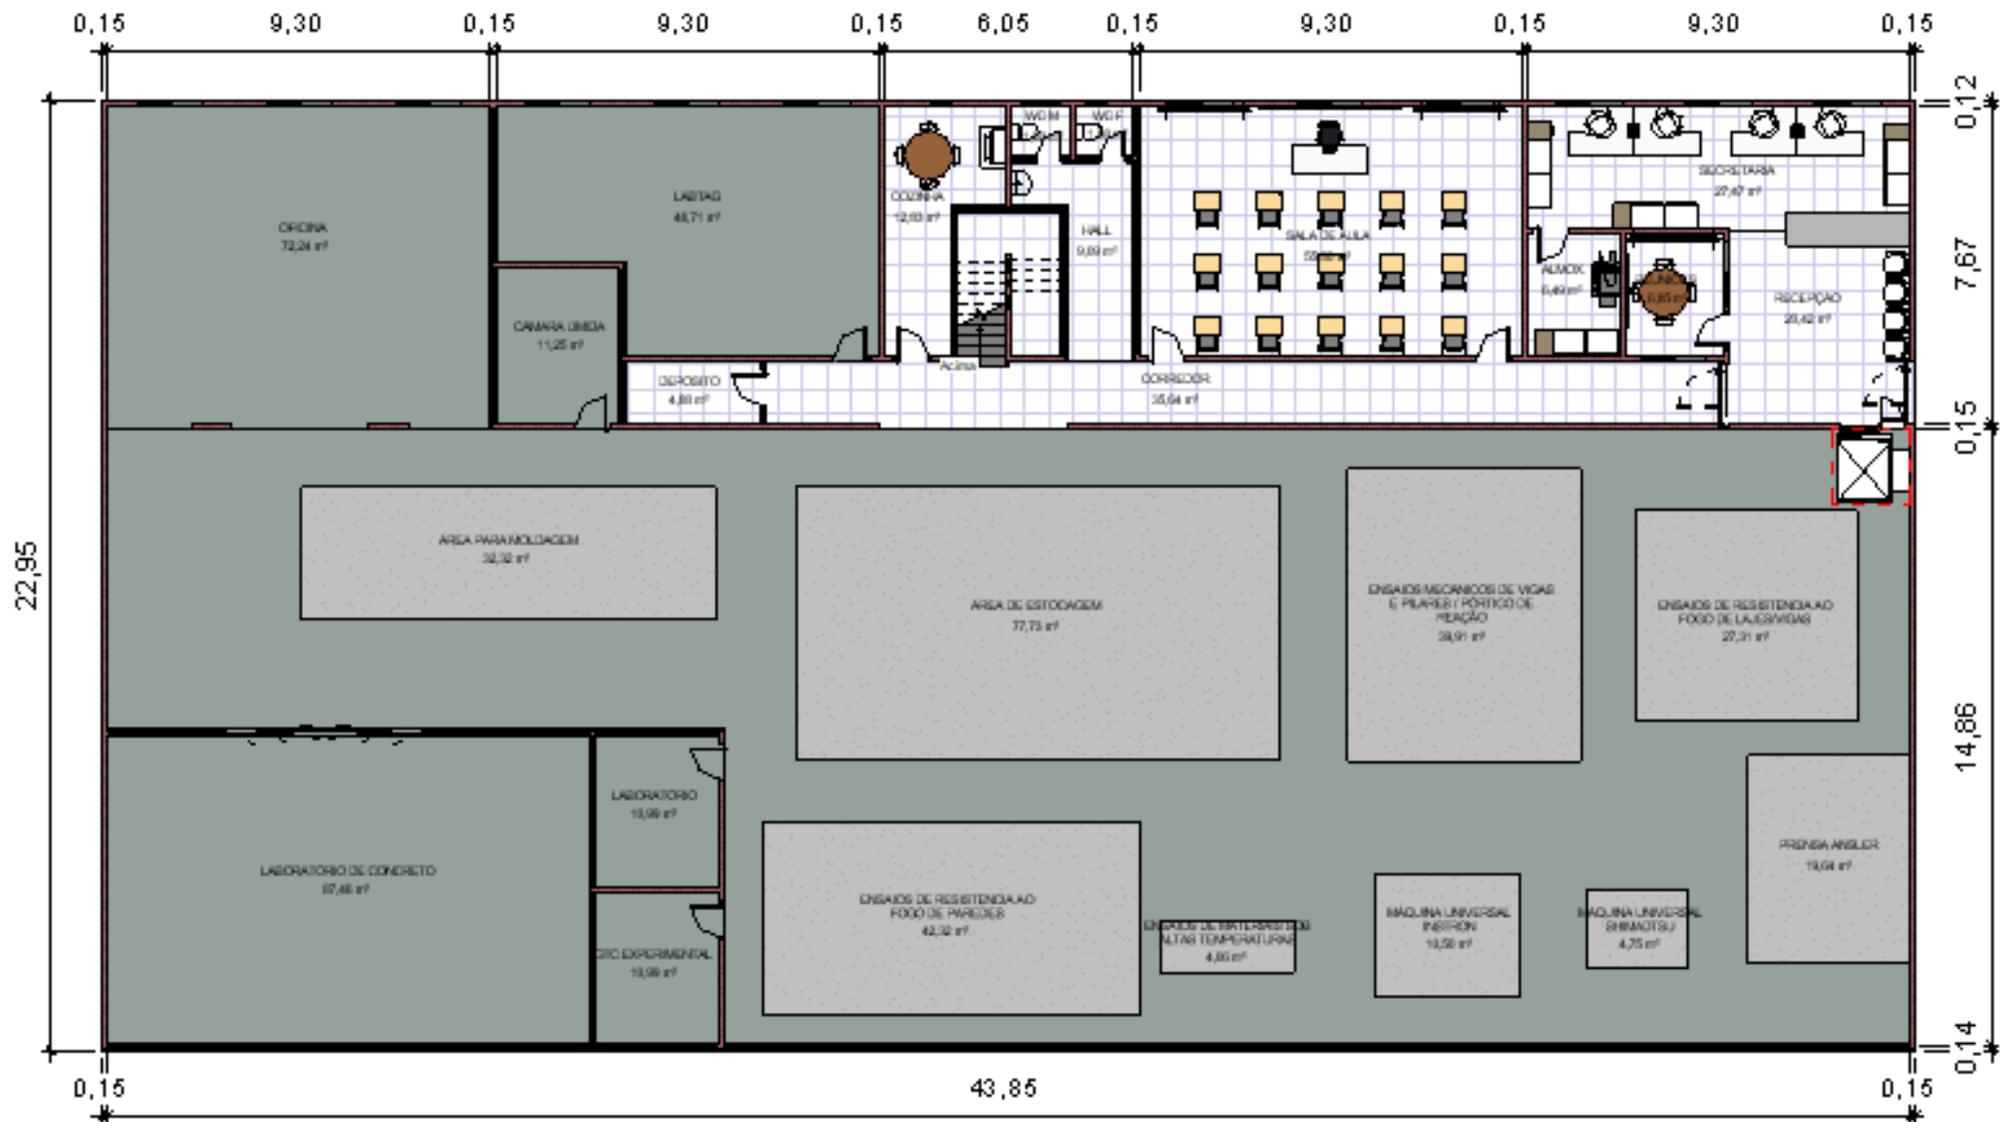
Planta Baixa do Laboratório de Análise Estrutural e de Materiais do DECIV/CTG/UFPE – Pavimento Térreo
